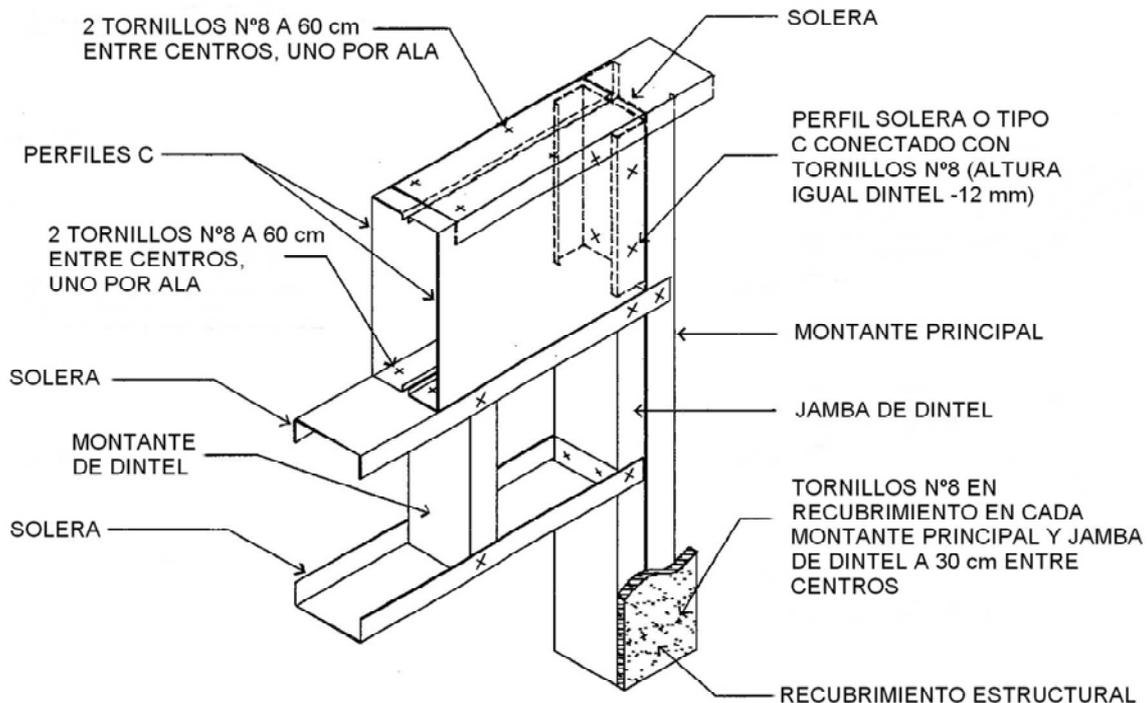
Detalle de montaje de viga dintel; Fuente: MAnual de steel framing
